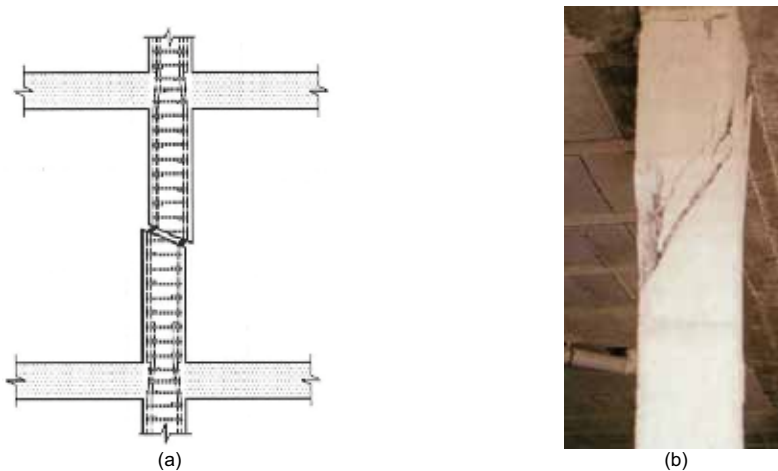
Agrietamiento inclinado de pilar. (Fuente: (a) Calavera, 2005. (b) Fernández, 1994)
